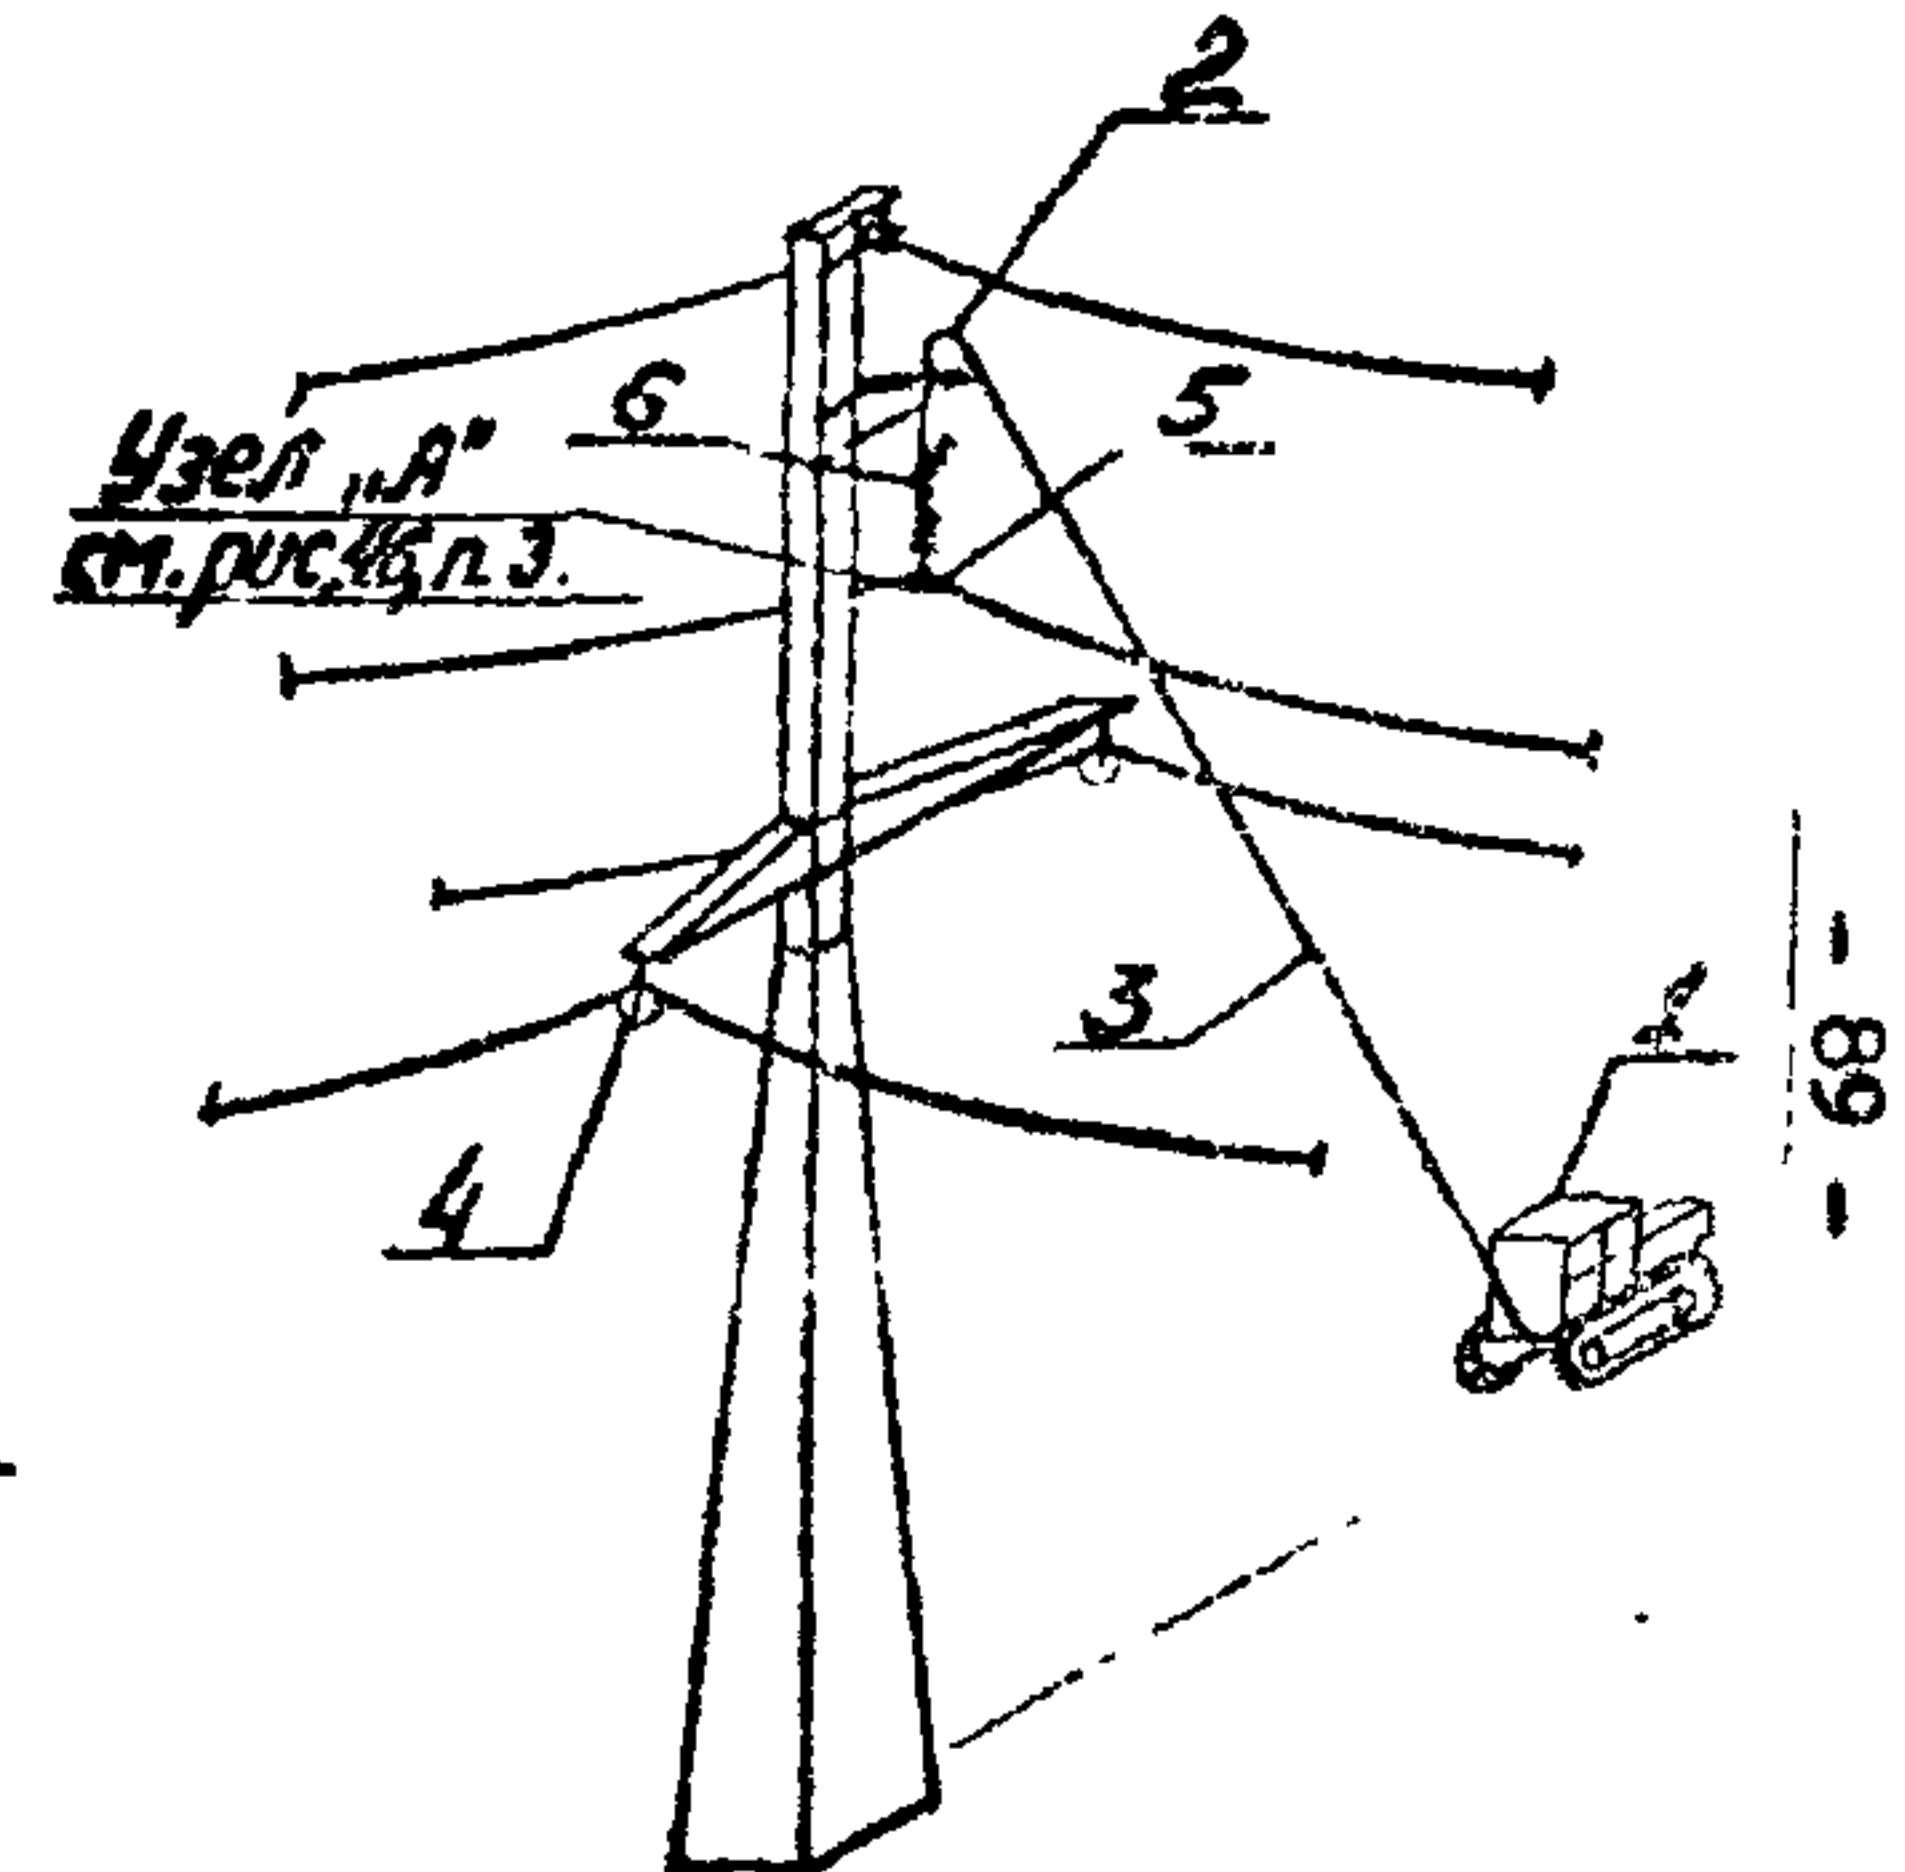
Перекладка проводов верхней траверсы с опусканием на
